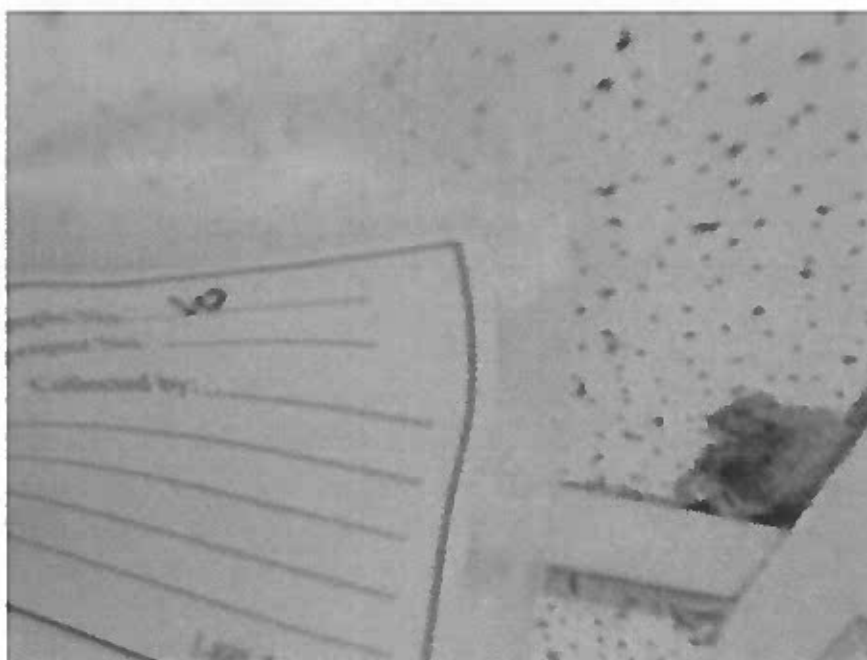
Local C-124 – Rez-de-chaussée (section rénoverée) – Tuile acoustique 2'X4'
